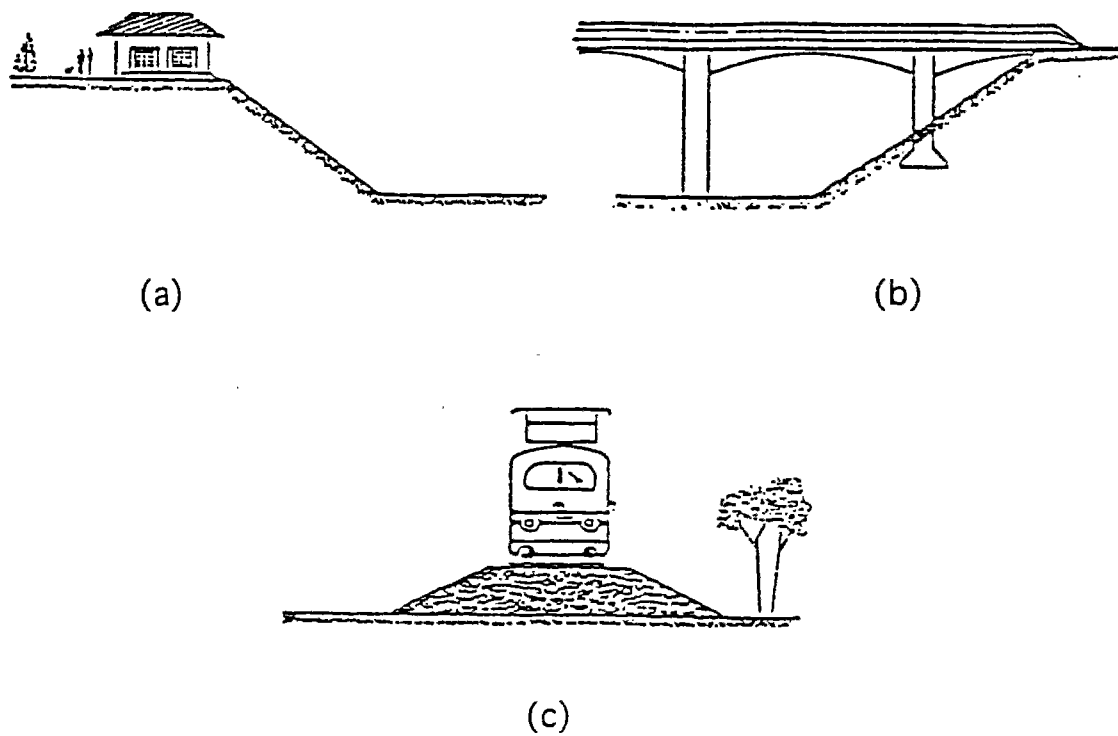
Exemples de situations mettant en jeu un problème de fondation à proximité d'une pente (d'après Giroud et al. (1971))
